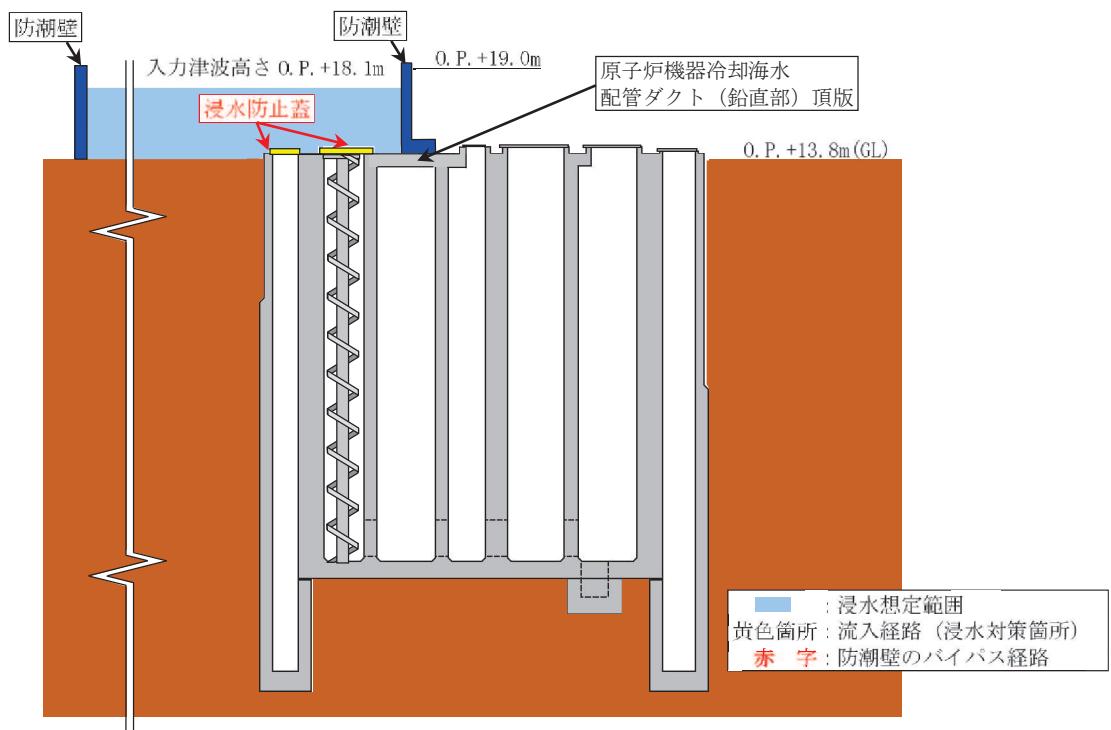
第 2 号機 海水ポンプ室 淹水対策配置図 (B-B 断面図)
